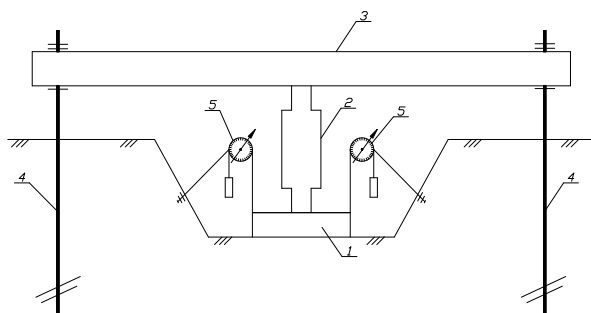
Схема установки для испытания грунта штампом в шурфе:
